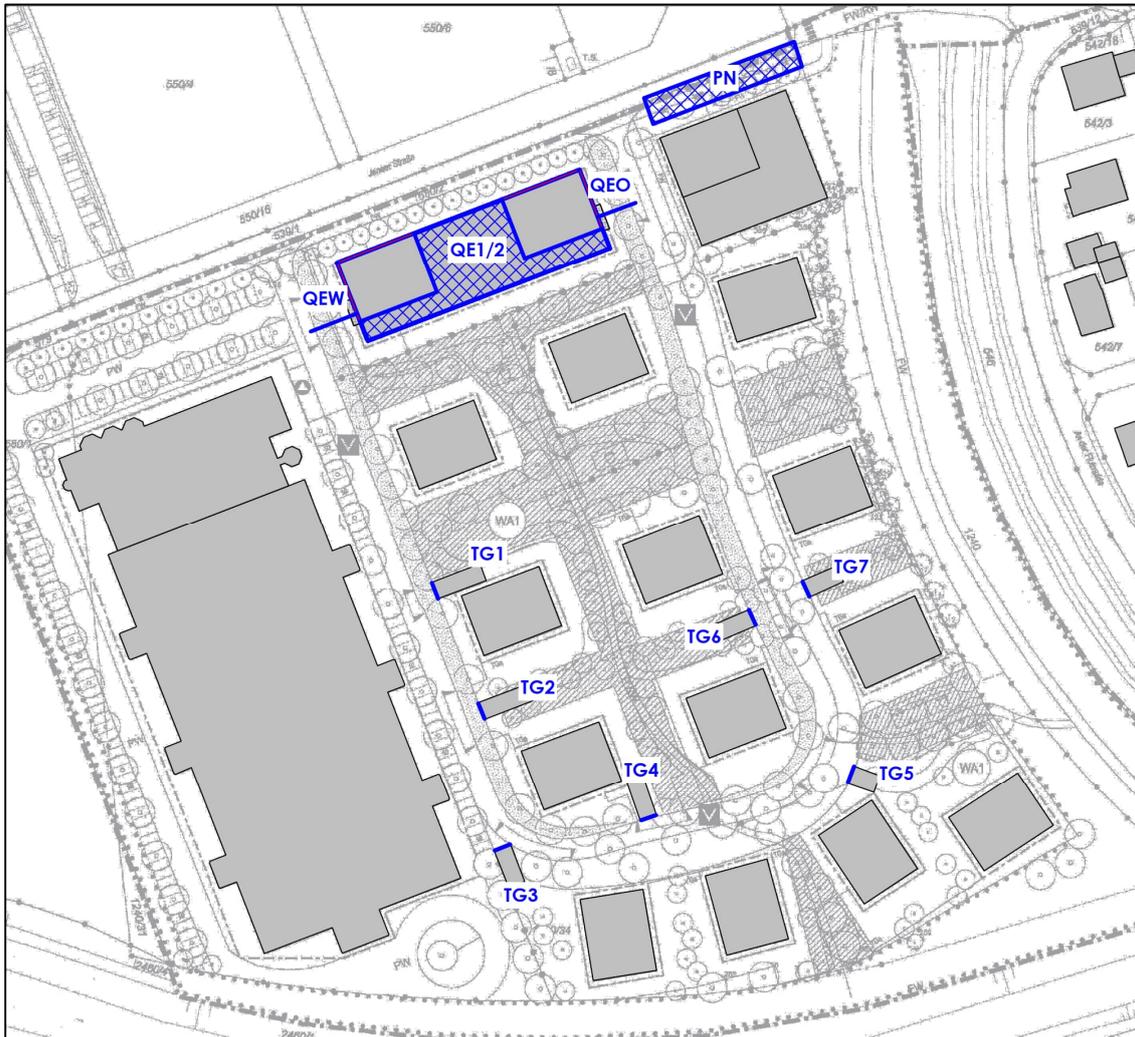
Lageplan mit Darstellung der relevanten Schallquellen zur Ermittlung der Parkplatzgeräuschemissionen
